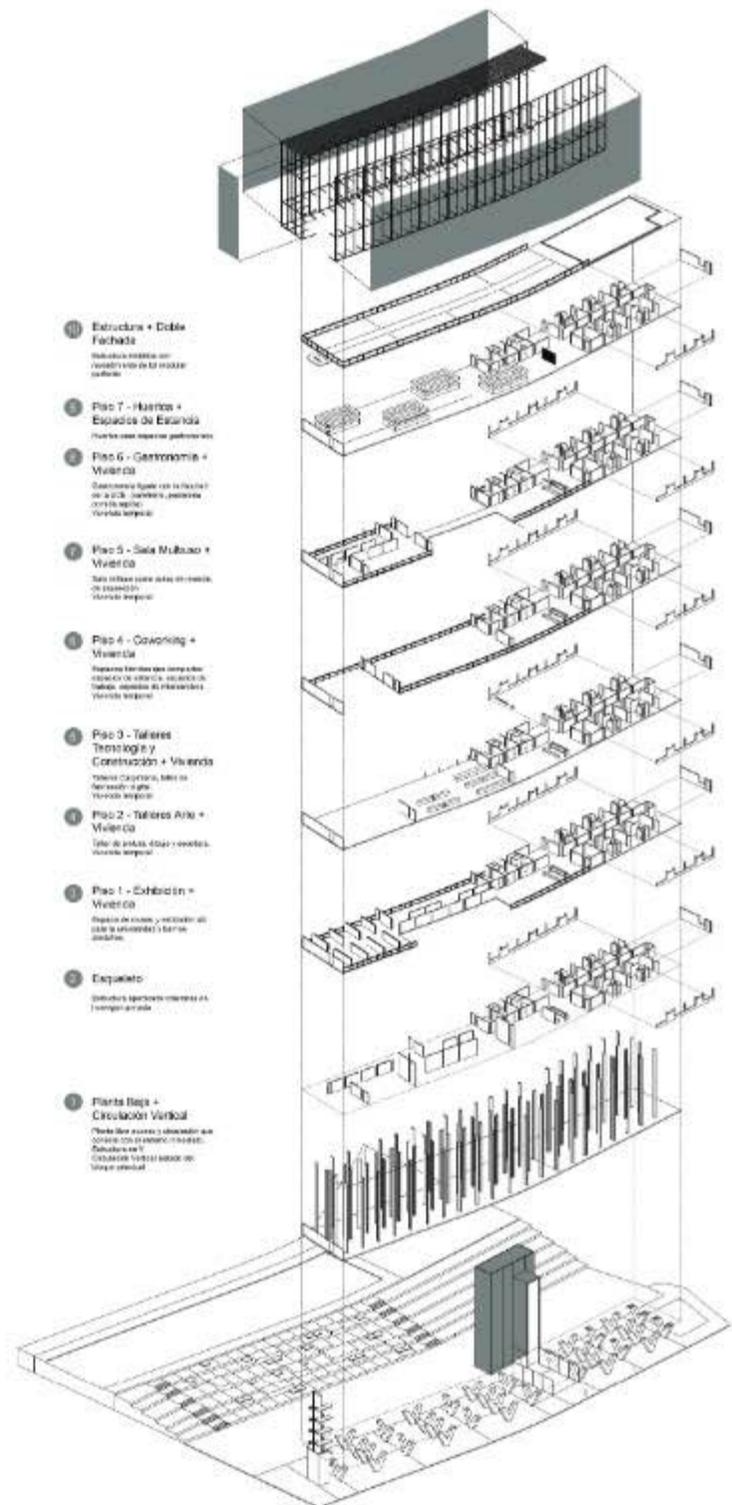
Axonometría explotada de Plantas Arquitectónicas - propuesta
